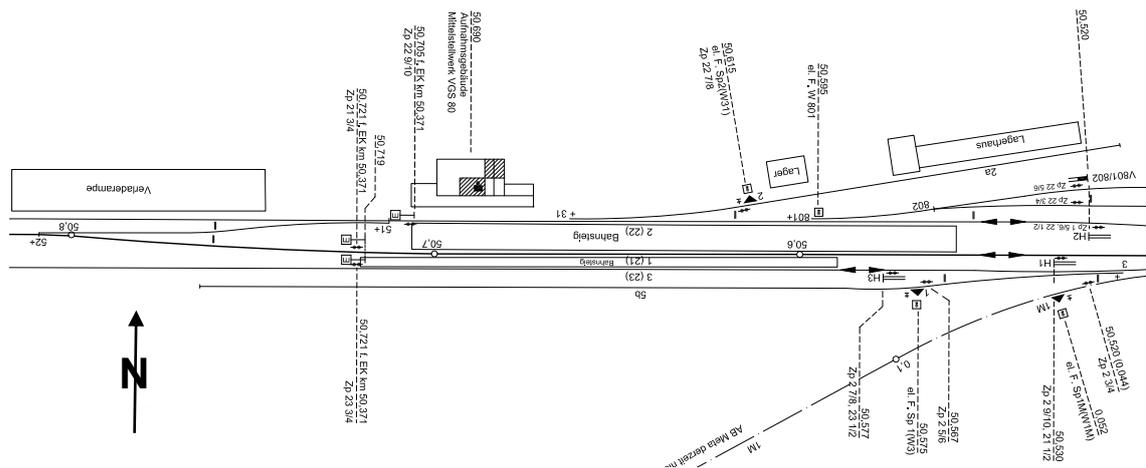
Bahnhof Wies: Sicherungstechnischer Lageplan⁶³
